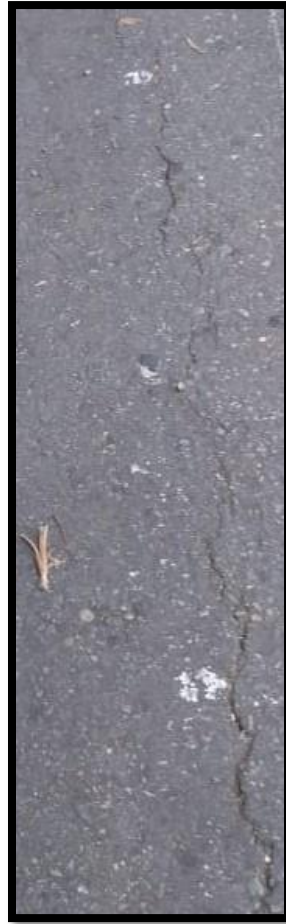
Fisura en Junta de Construcción Longitudinal (FCL).
